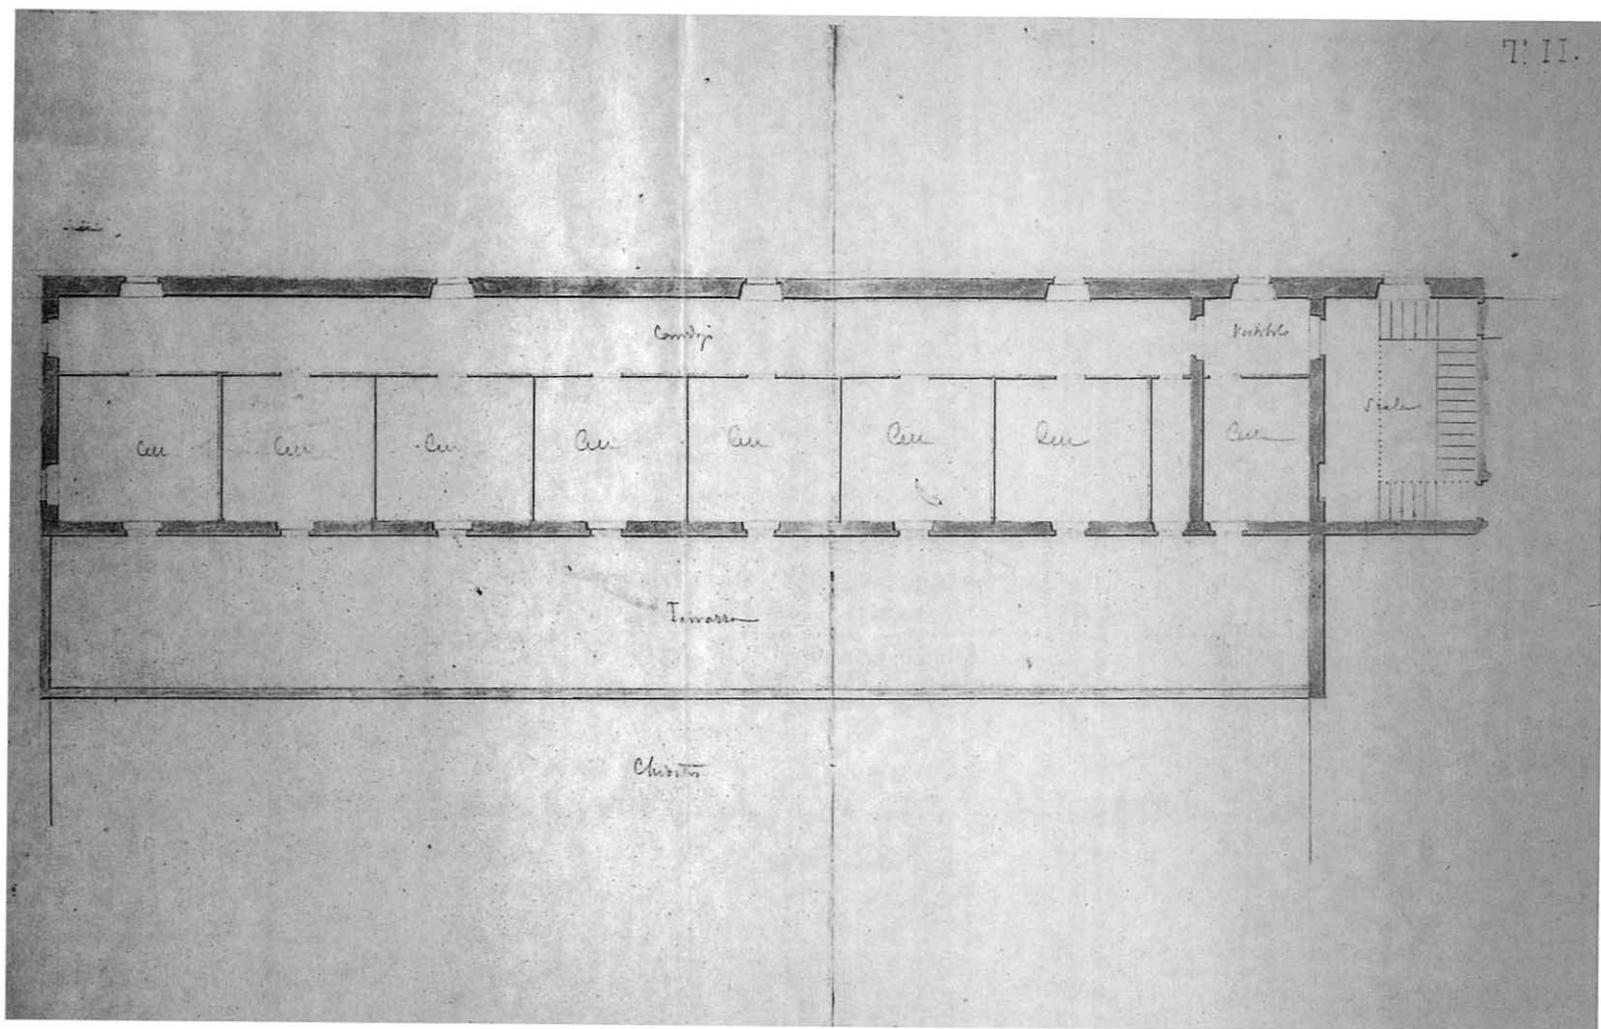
A. Busiri: Convento di S. Pietro in Vincoli, pianta del secondo piano modificata (ASR 15/98)
